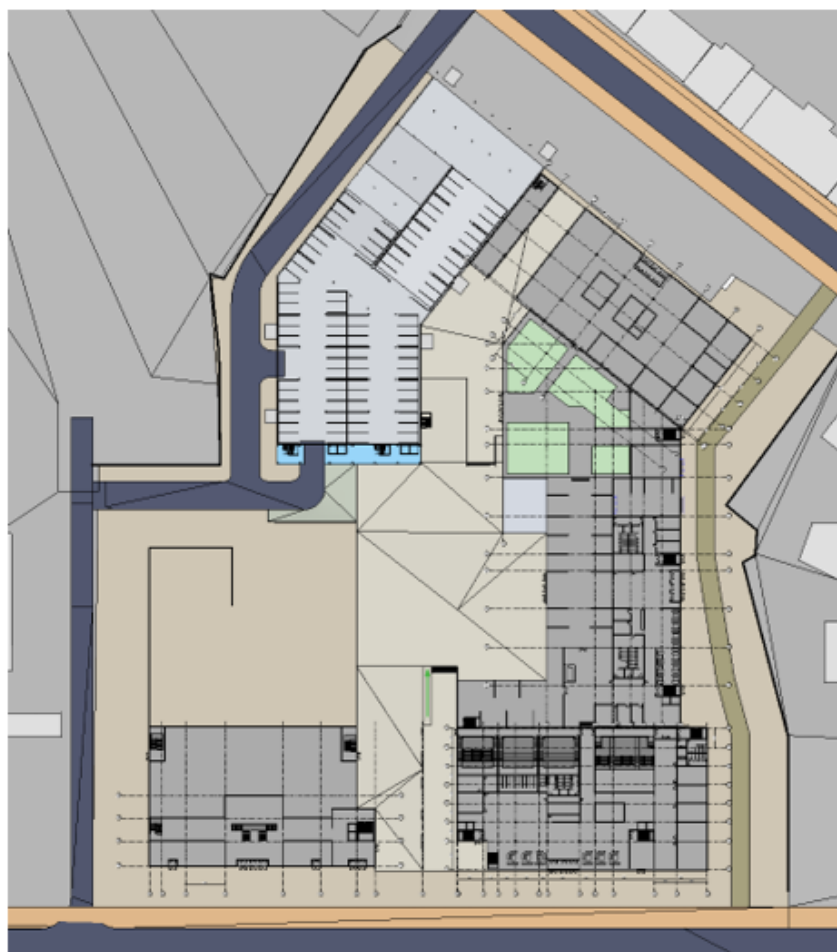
Ситуаційний план ГЕС, та самої будівлі
